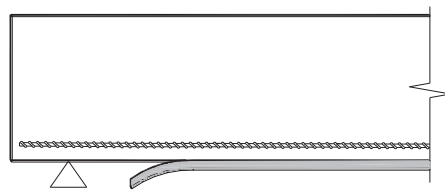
Fallas en el adhesivo entre la viga y la platina FRP.
